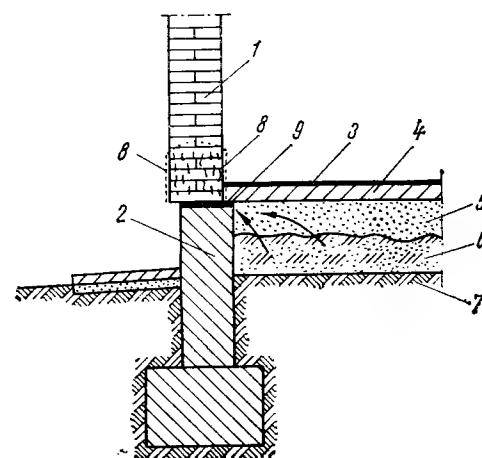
Pardoseală din PVC pe suport de beton la parter, soluție constructivă necorespunzătoare:
